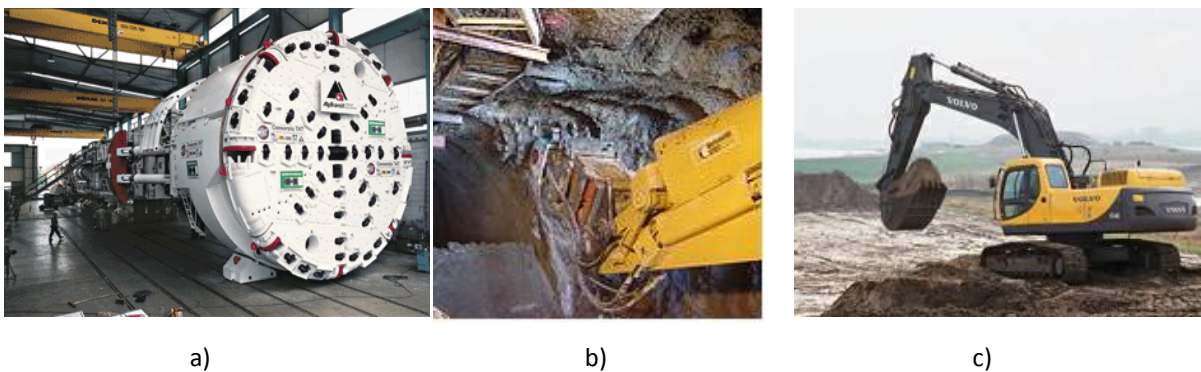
Equipamentos – a) TBM; B) Máquina de ataque pontual; C) Escavadora giratória.
